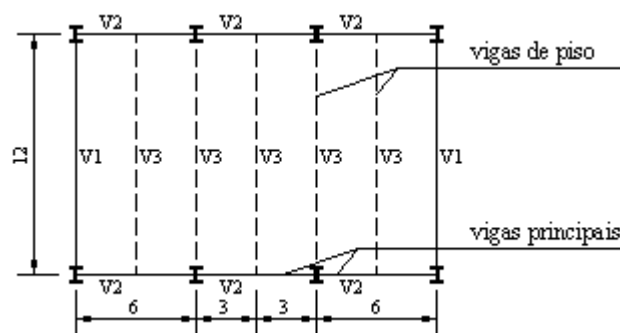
Planta esquemática do vigamento de piso – situação 01 (medidas em m)
